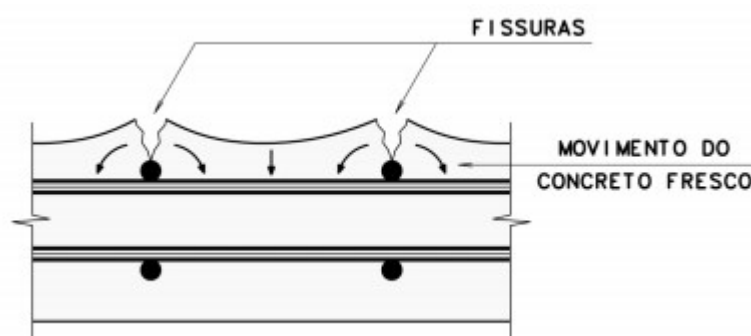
Fissuras causadas pelo assentamento plástico do concreto.
